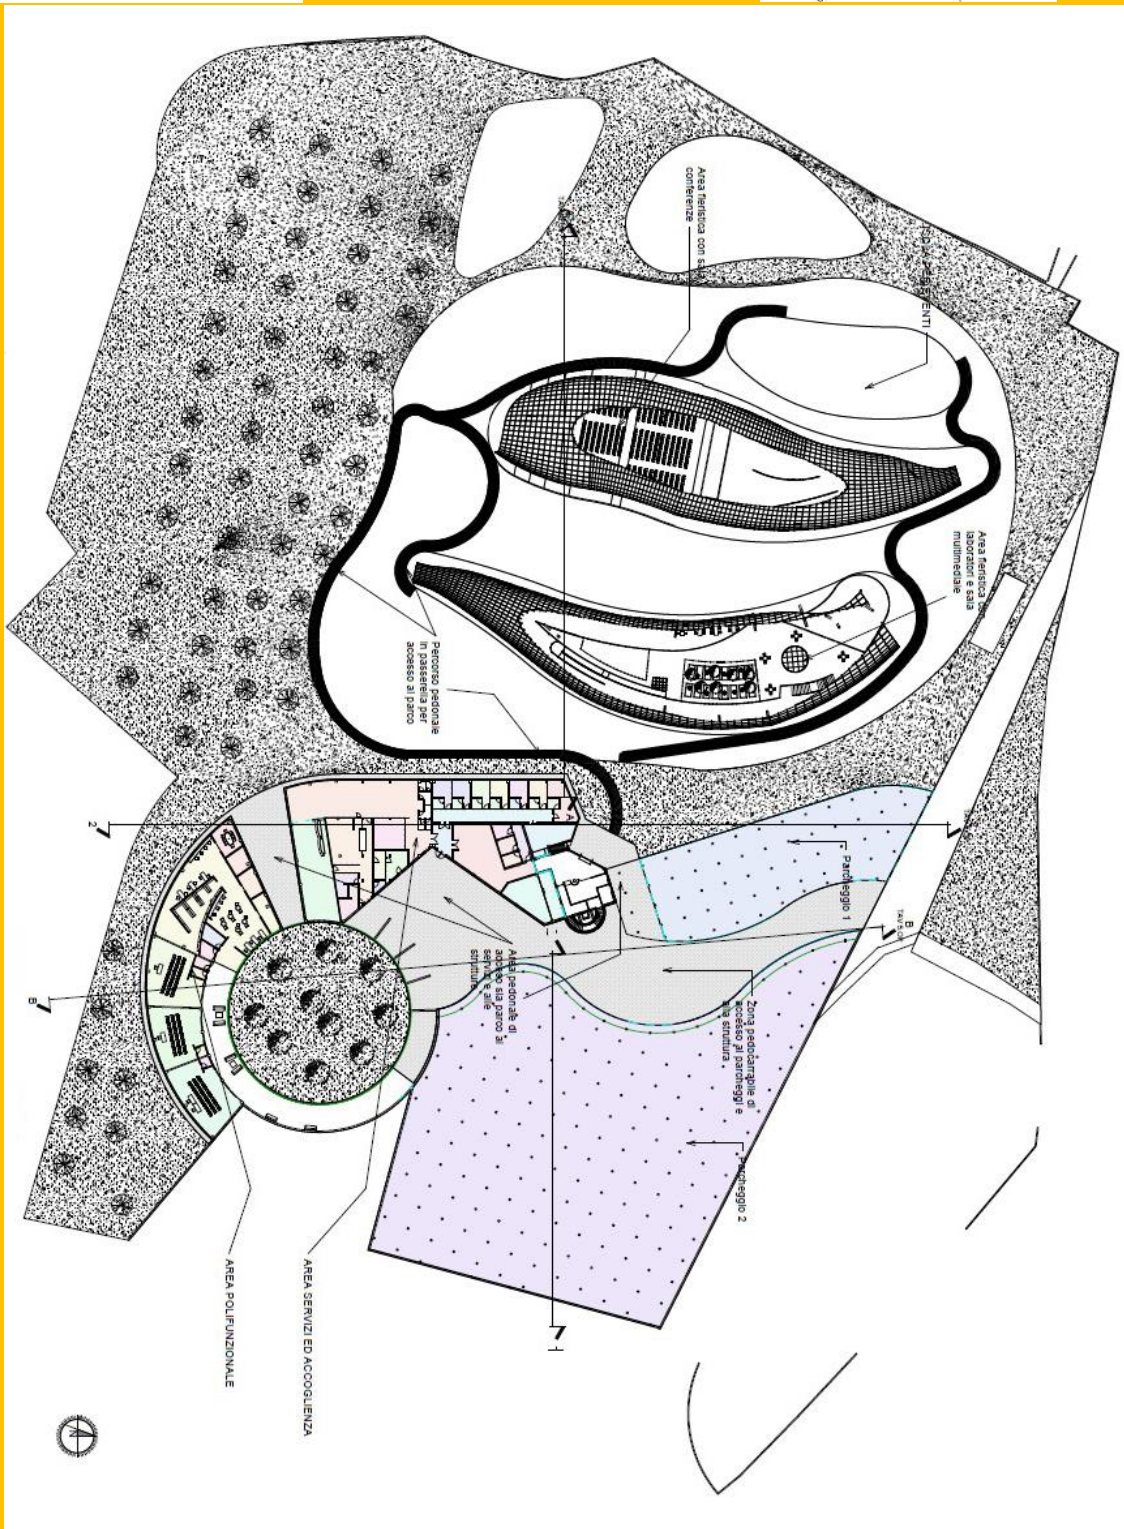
PLANIMETRIA GENERALE. © STUDIO MULTIVERSE A.T.P.
